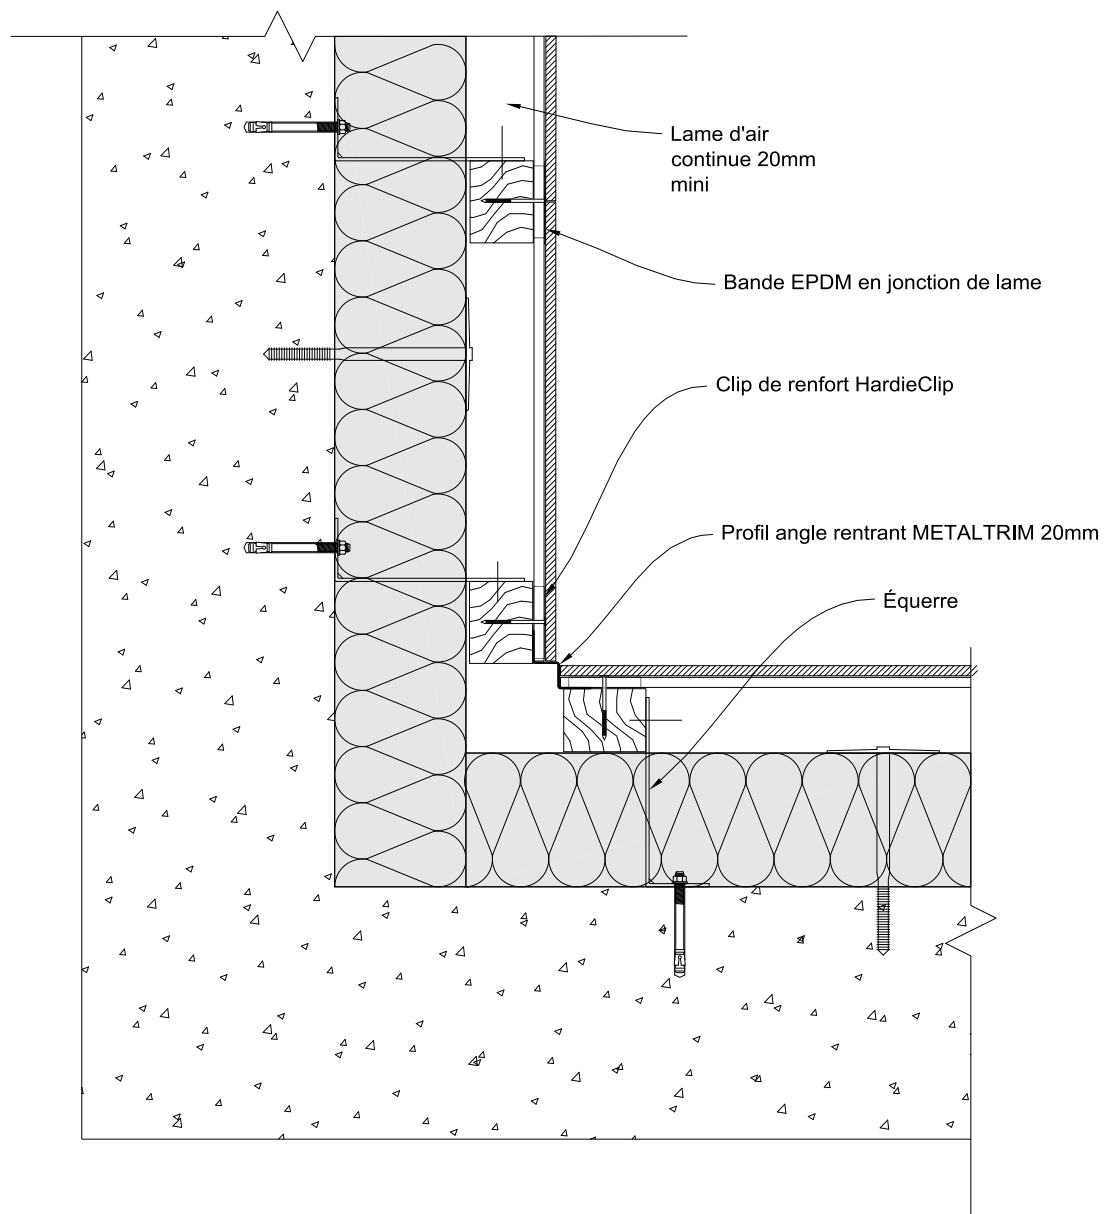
Coupe verticale sur acrotère – ossature bois
